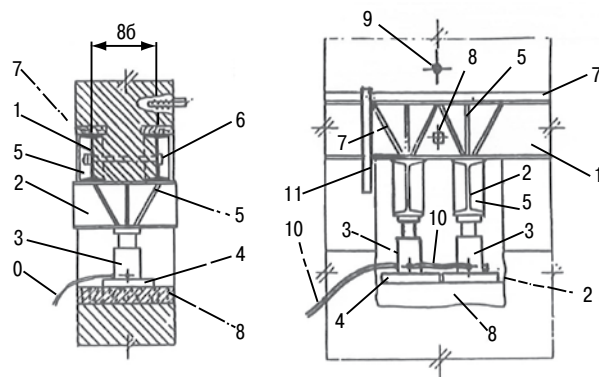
Схема расположения оборудования в домкратном проеме: 1 – обвязочная балка; 2 – распределительная балка; 3 – домкрат; 4 – стальная распределительная плита; 5 – ребро жесткости; 6 – стяжной болт; 7 – доска; 8 – железобетонная подушка; 9 – репер; 10 – маслопровод; 11 – линейка; 12 – крюк для подвески линейки
